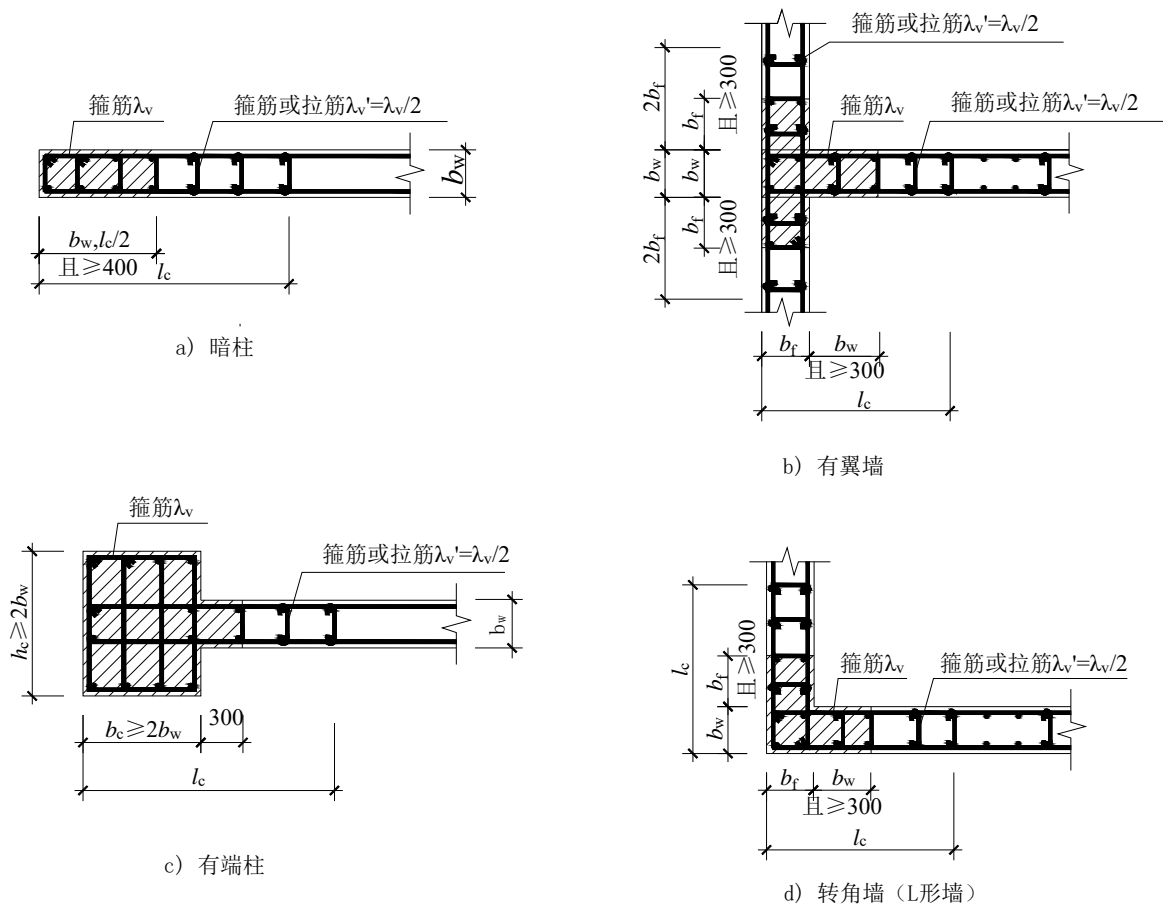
预制剪力墙的后浇混凝土约束边缘构件示意
